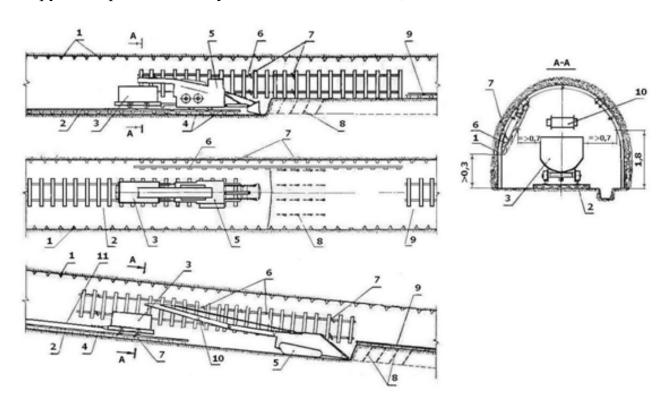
Схема размещения оборудования Условные обозначения: 1 — рамы крепи (остальные детали условно не показаны); 2 — вновь уложенный рельсовый путь; 3 — вагонетка; 4 — временный рельсовый путь; 5 — погрузочная машина; 6 — демонтированные звенья рельсового пути; 7 — отрезки цепи 18х64; 8 — шпуры; 9 — существующий рельсовый путь; 10 — конвейер погрузочной машины; 11 — канат
